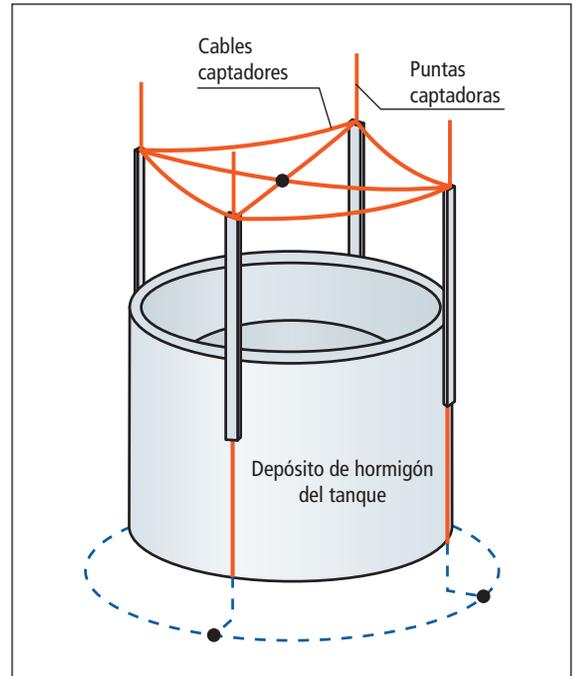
Dispositivos captadores para un tanque con puntas y cables captadores.
